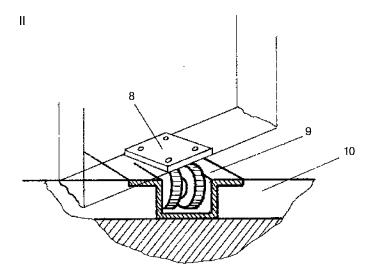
(продолжение). Поворачивающаяся дверь: 1, 11 — конструктивные углы двери: 1, 2 — положение полотна двери в открытом и закрытом состоянии; 3 — заполнитель; 4 — доска; 5 — металлическая направляющая; 6 — ролик; 7 — конструкция полотна двери; 8 — металлическая пластина; 9 — углубление в полу для движения роликов; 10 — конструкция пола
